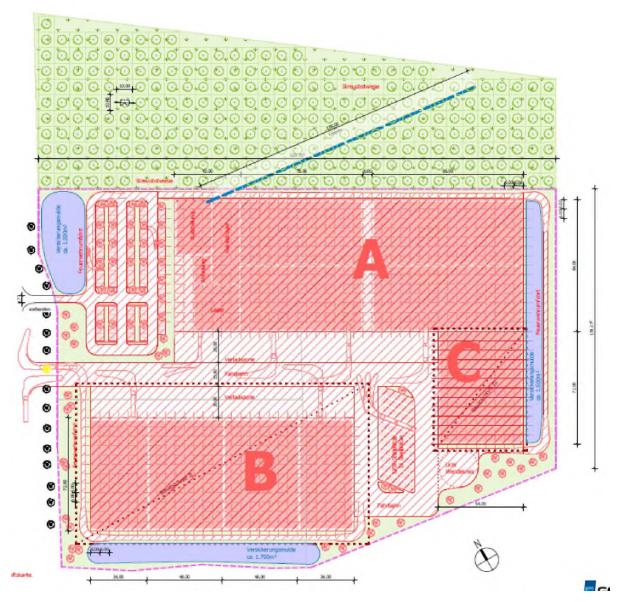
Lageplan ohne Maßstab /46/ Vorplanung innerhalb des Plangebietes
